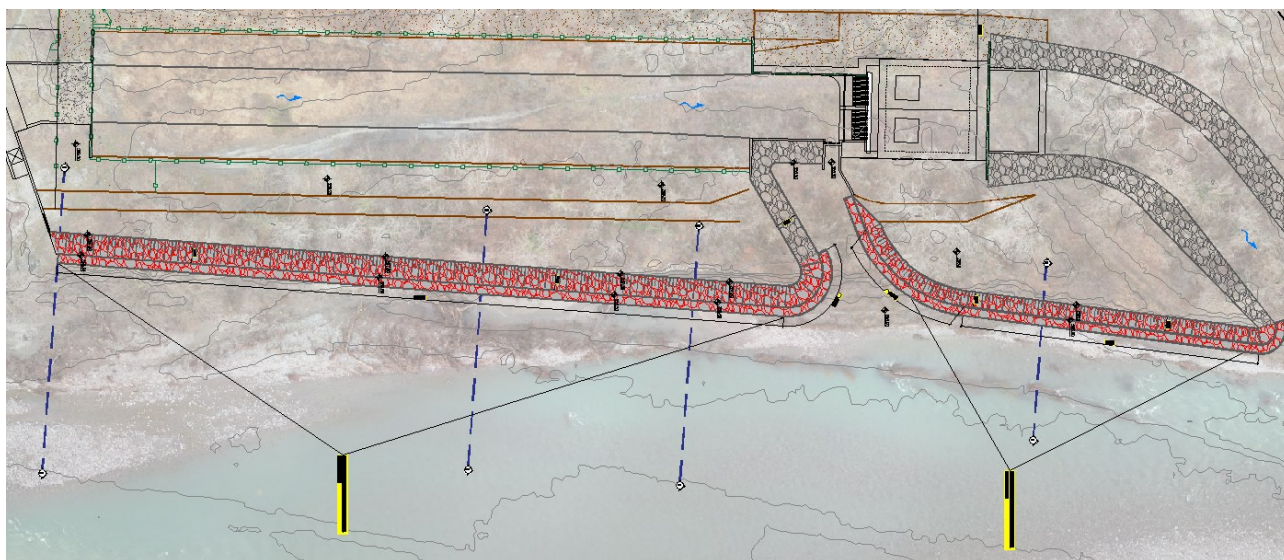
stralcio planimetrico con l’indicazione delle due difese spondali in variante al progetto (in rosso)
